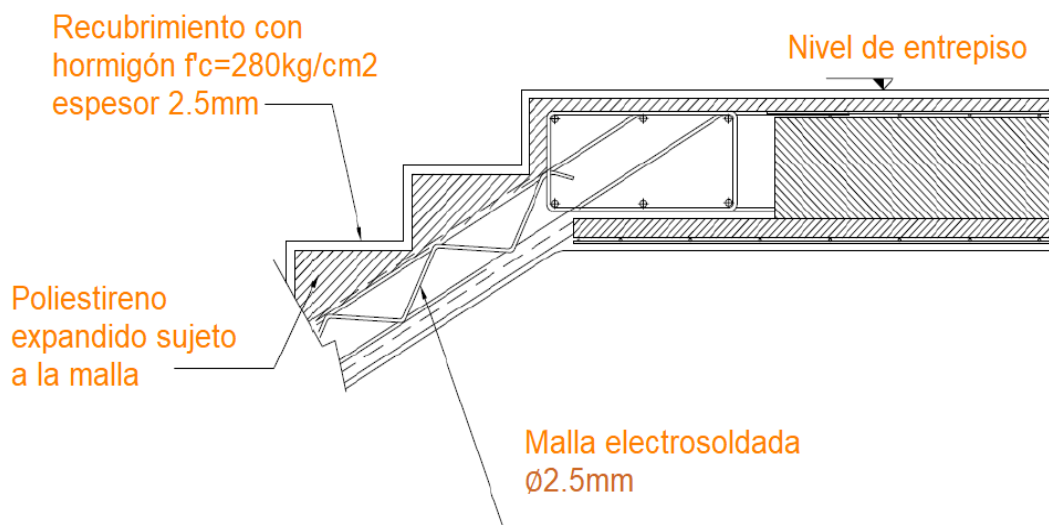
Detalle gradas del panel escalera (ELEVACIÓN)
